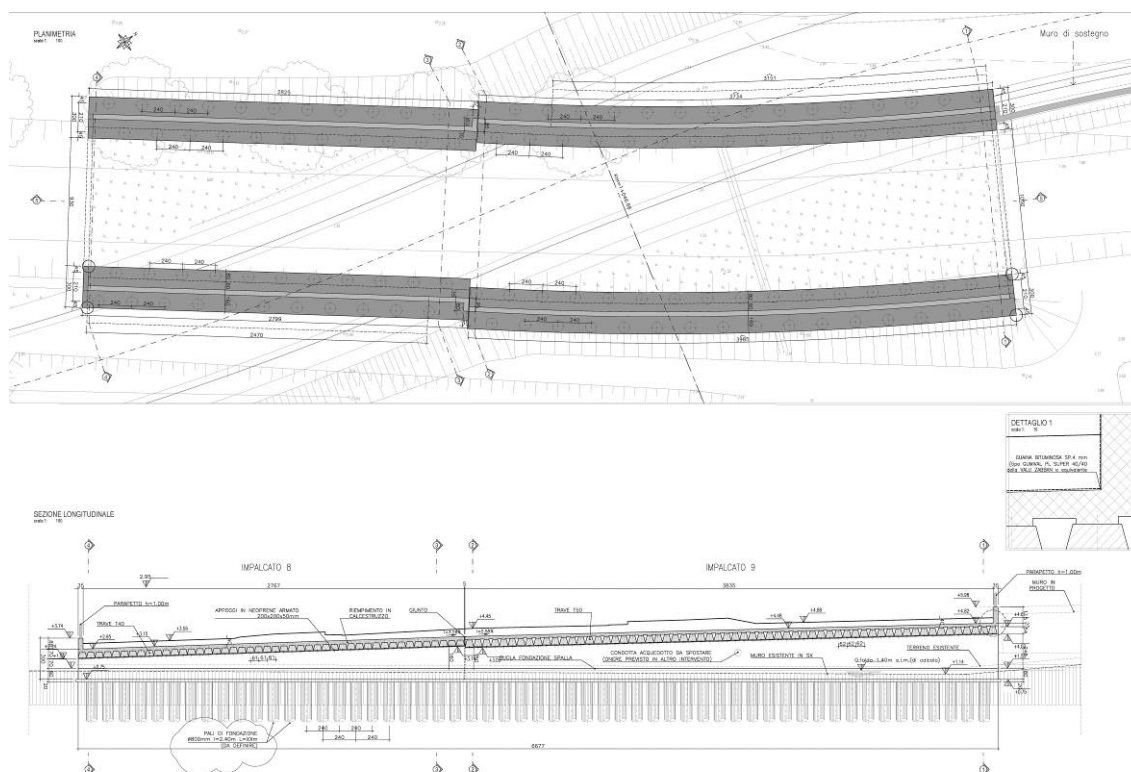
Impalcato 8 e 9 – Pianta e sezione longitudinale
